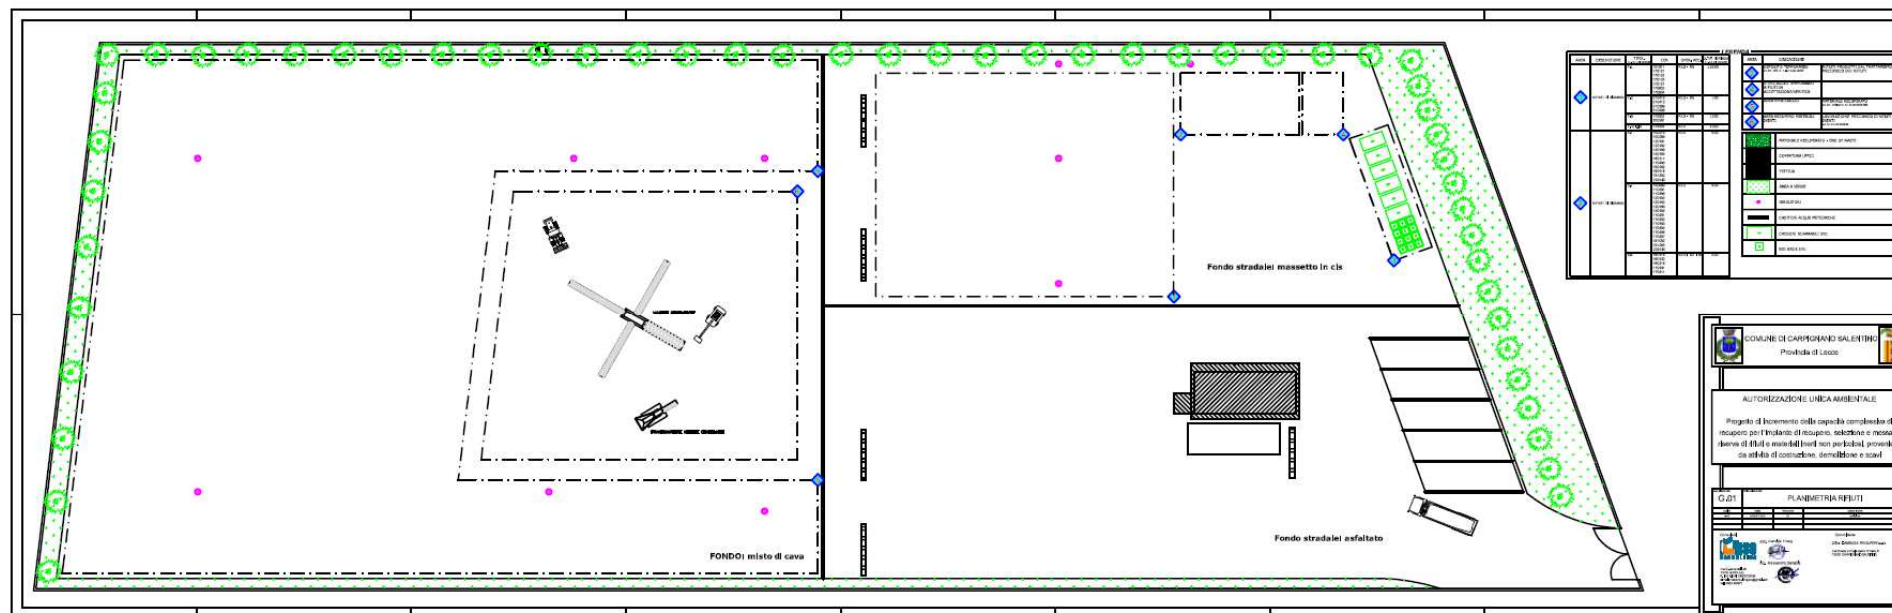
Planimetria ZAMINGA RECUPERI S.r.l.s.
